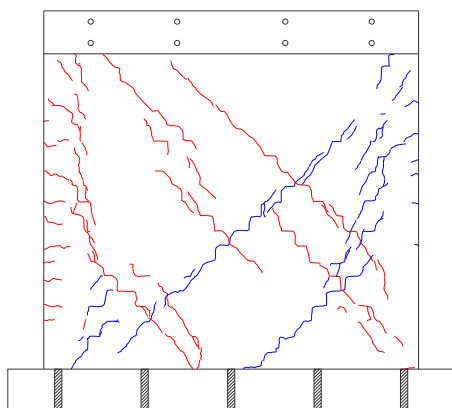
Reparación Tipo I en muro de albañilería confinada con ladrillos sólido artesanal en la distorsión 1/800.
